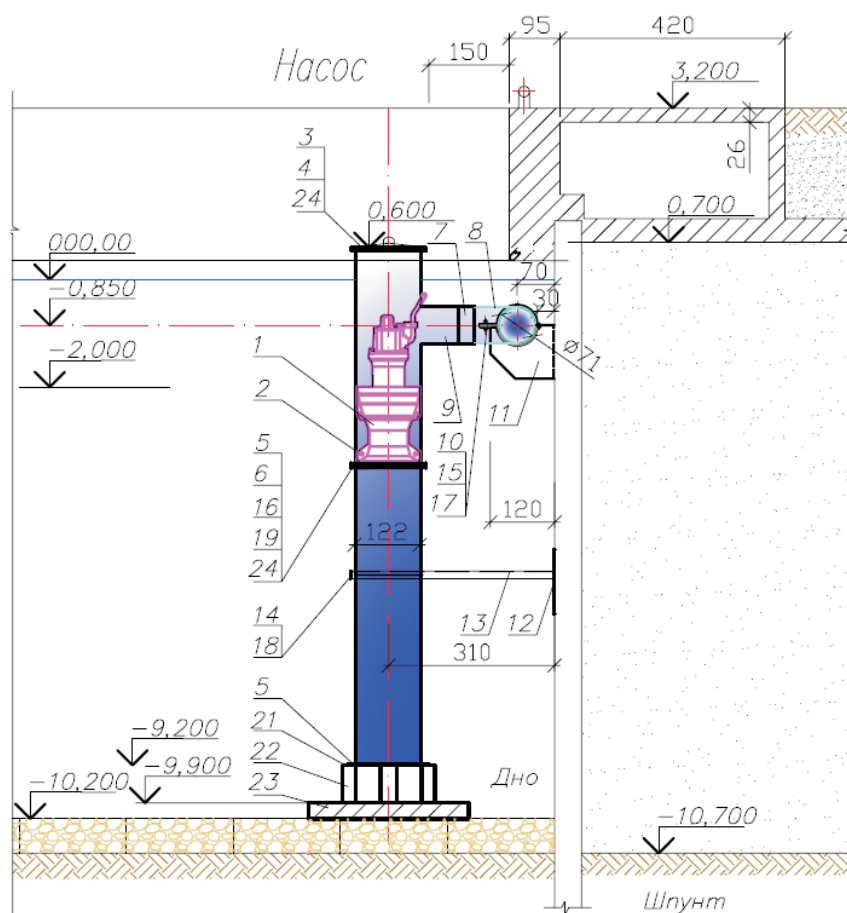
Схема размещения перфорированного трубопровода насосной установки
